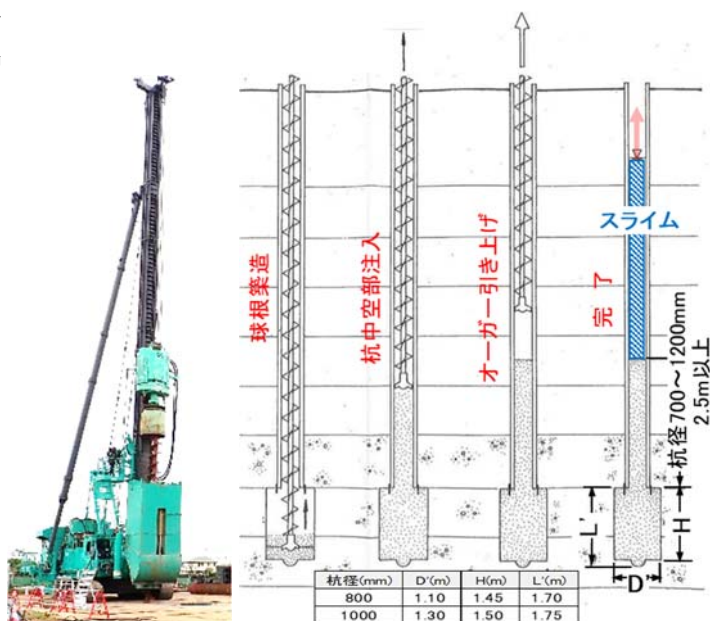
中掘り拡大根固め工法 図-1 拡大根固め築造 施工手順図 (STJ工法施工要領書より引用・加筆)
